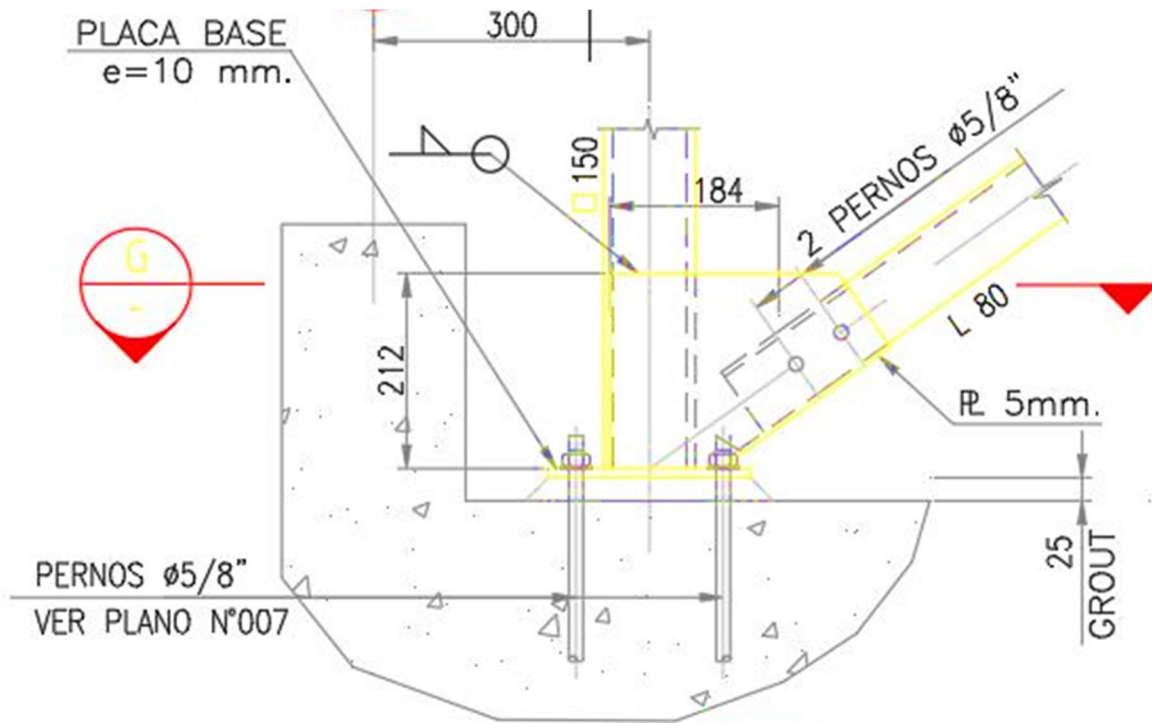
Detalle de anclaje y conexión de arriostramiento lateral a base de columna.
